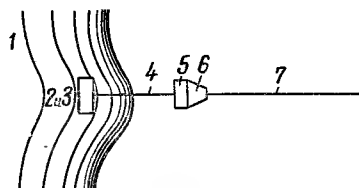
Плавучая насосная станция (разрез вдоль трассы водоводов) и план узла ее:
